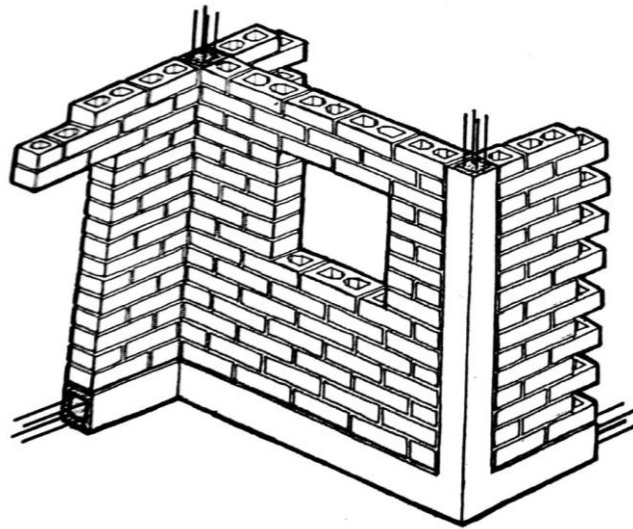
Esquema estructural de la mampostería en ladrillo confinado. Adaptado de Maldonado Rondón y Chío Cho (2007). Visión estructural de las edificaciones de la ciudad de Bucaramanga.
